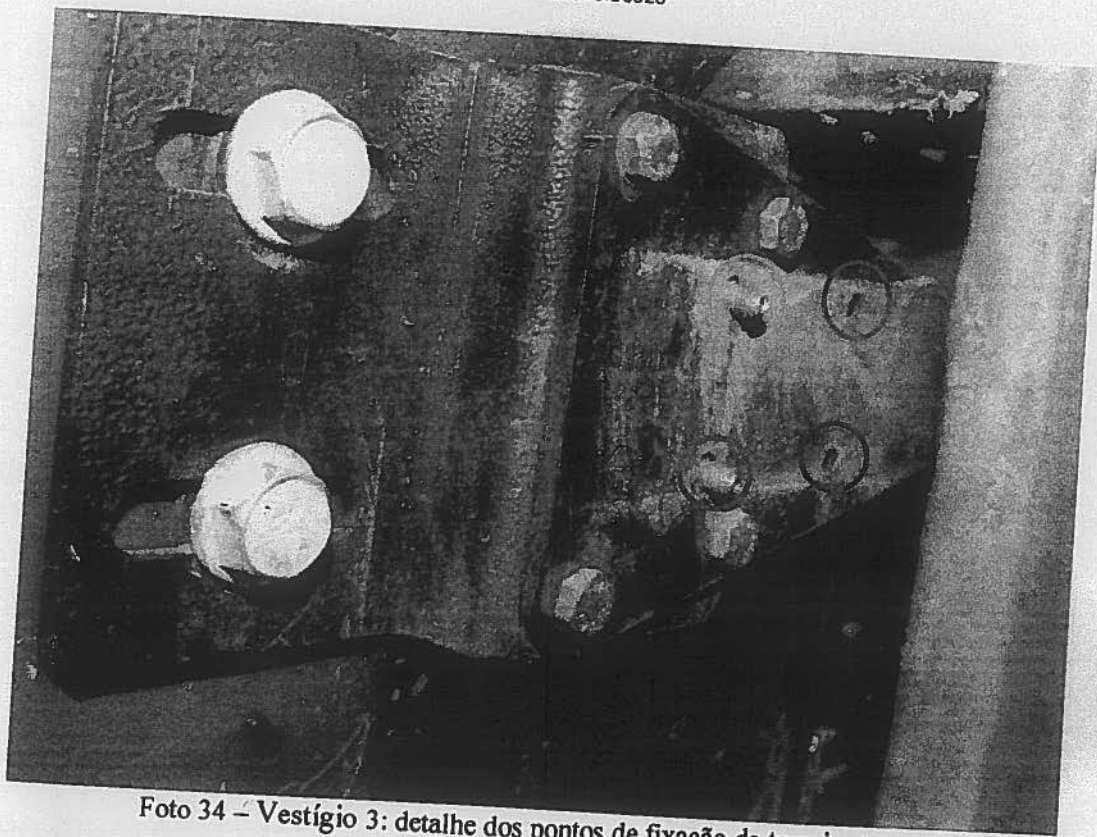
Vestígio 3: detalhe dos pontos de fixação da terceira trava.
